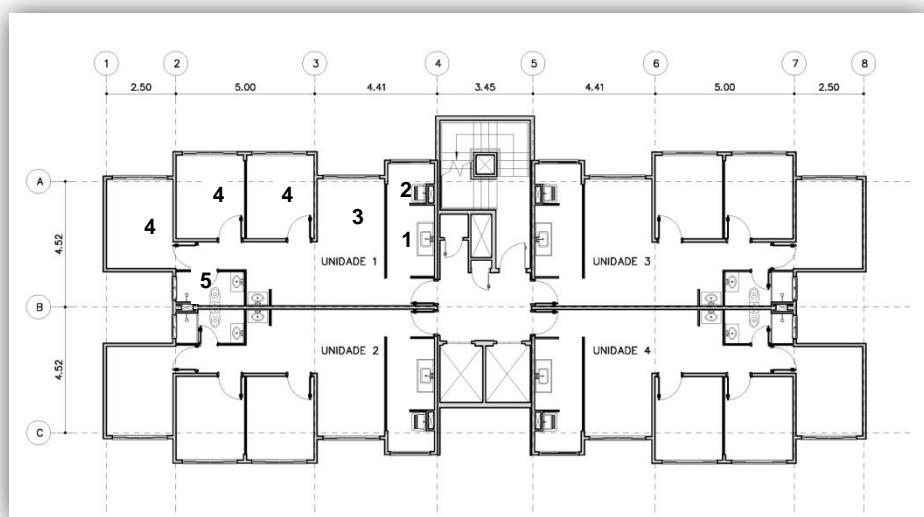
V093 – Planta do pavimento térreo; sem escala.
